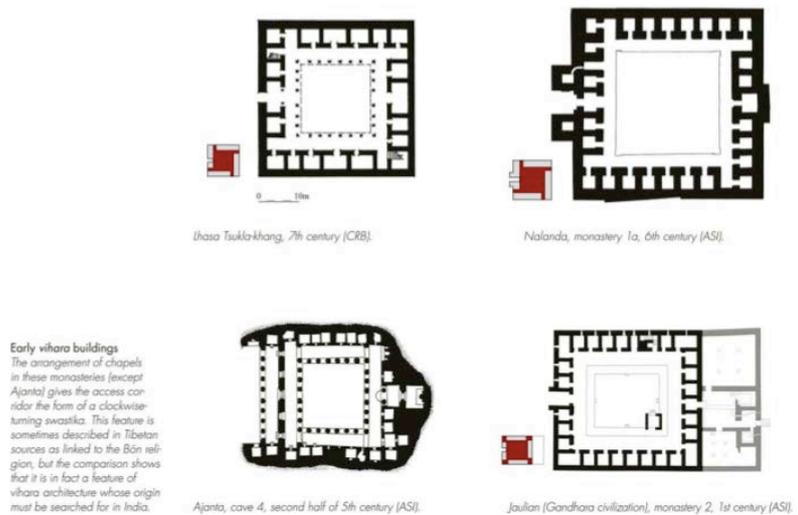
Entwicklung der Grundrisse Lhasa Tsukla-khang, Jaulian, Ajanta, Nalanda (Alexander 2005)
